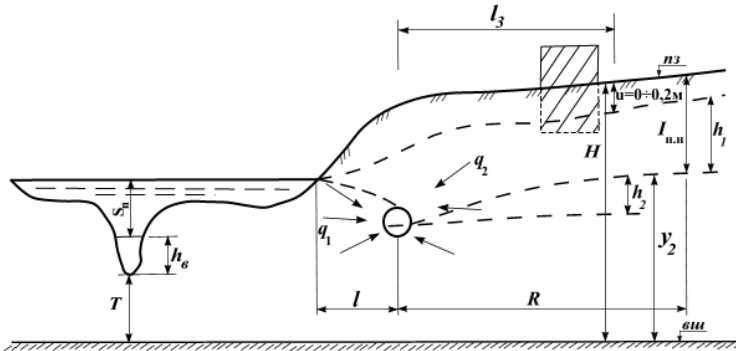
Розрахункова схема до обґрунтування параметрів берегового горизонтального дренажу
